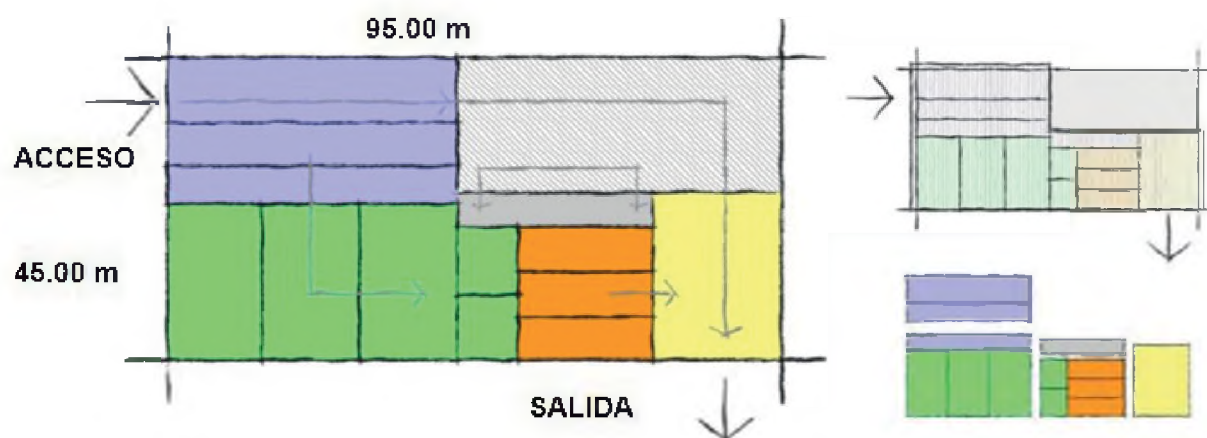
Esquemas en planta de alternativa 2. Fuente: elaboración propia
